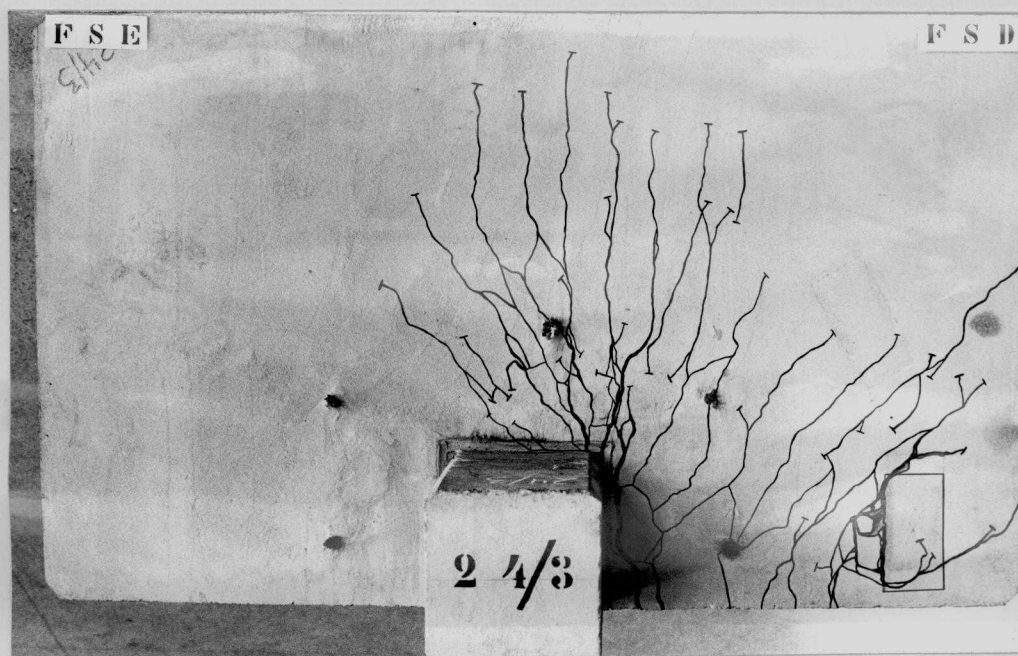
a - Fissuração na face superior do modelo EdL 24/3.
